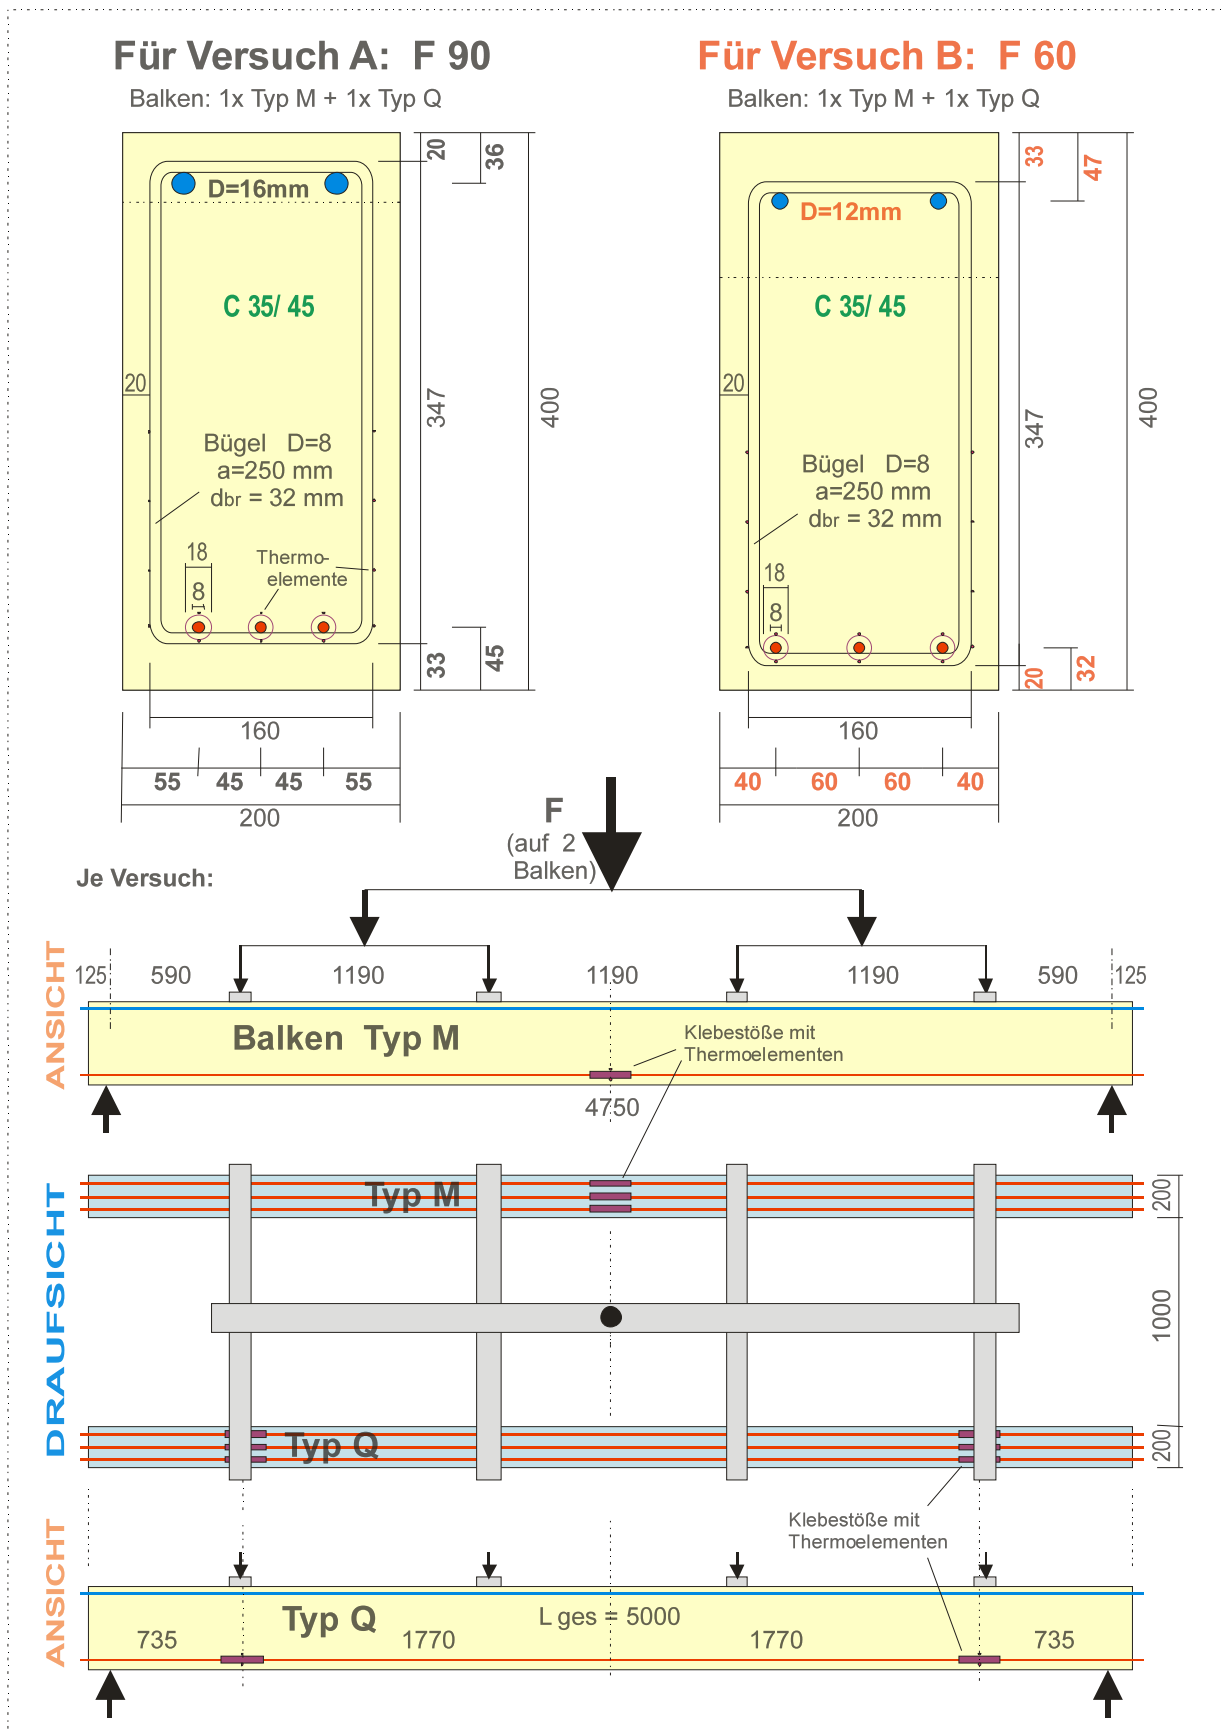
Aufbau und Abmessungen der Stahlbetonbalken sowie Versuchsaufbau
